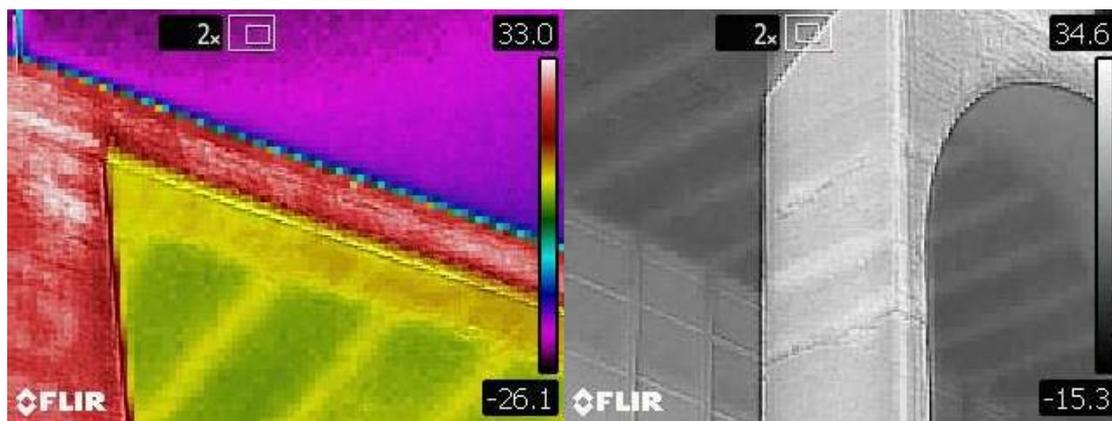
Fachada Norte – Vigas de bordo e pilar – concentração de calor na junta entre a viga e o pilar, e na face com problemas de cobrimento
